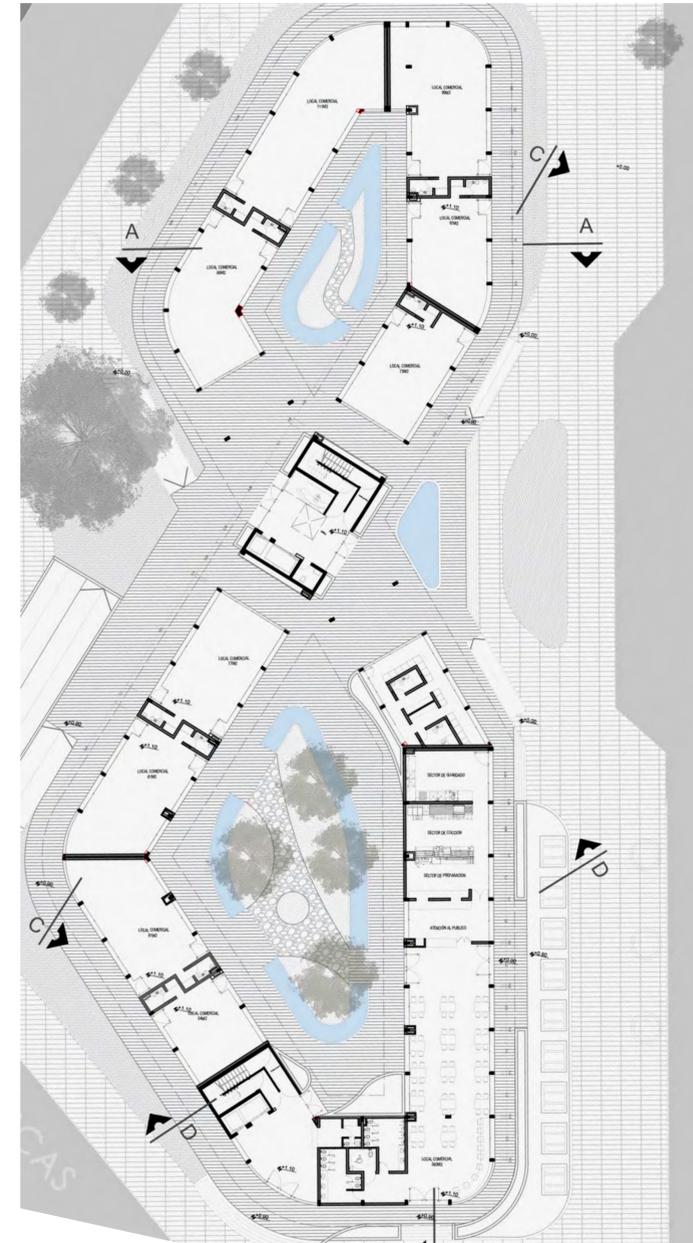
Planta. El cero del edificio es destinado a actividades comerciales, a las que se responde arquitectónicamente con una planta libre
